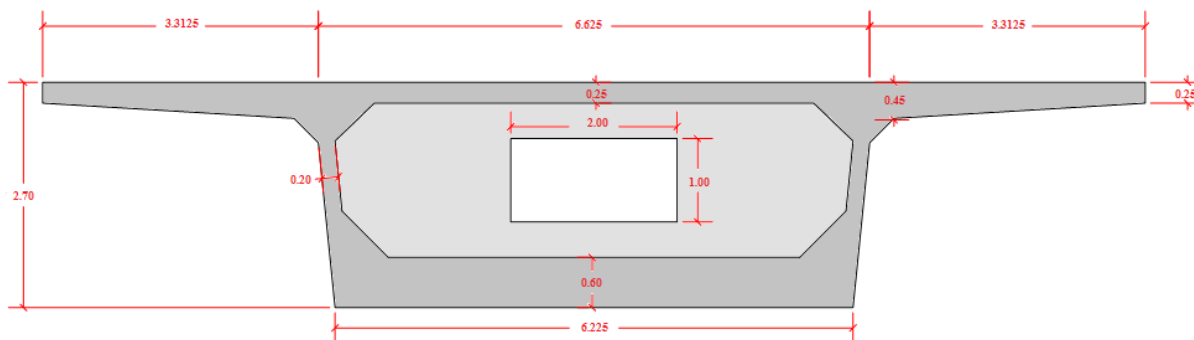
coupe transversale de voussoir sur pile -variante 2.
